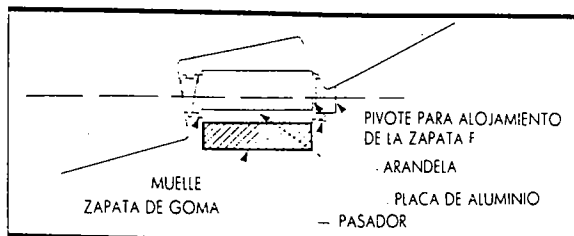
Detalle de la disposición de la zapata de goma.
